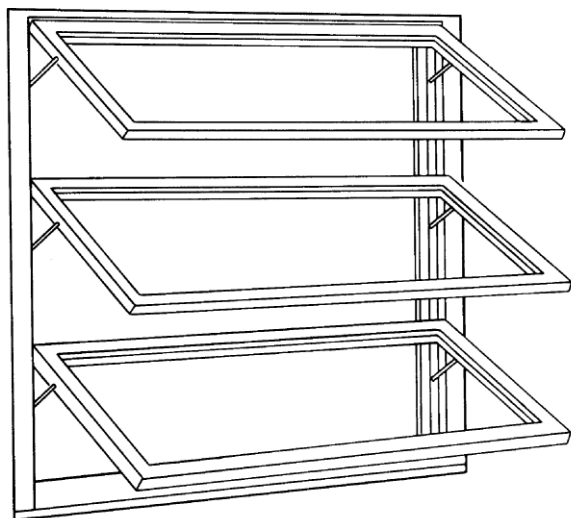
Вертикальный пакет последовательно установленных модулей с открывающимися створками
